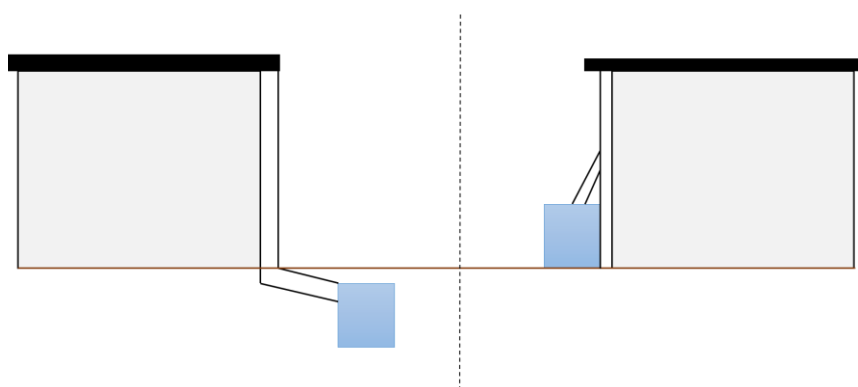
Schéma d'un bâti avec toiture plate, complété par un récupérateur d'eau enterré (gauche) ou accolé à la construction (droite)
